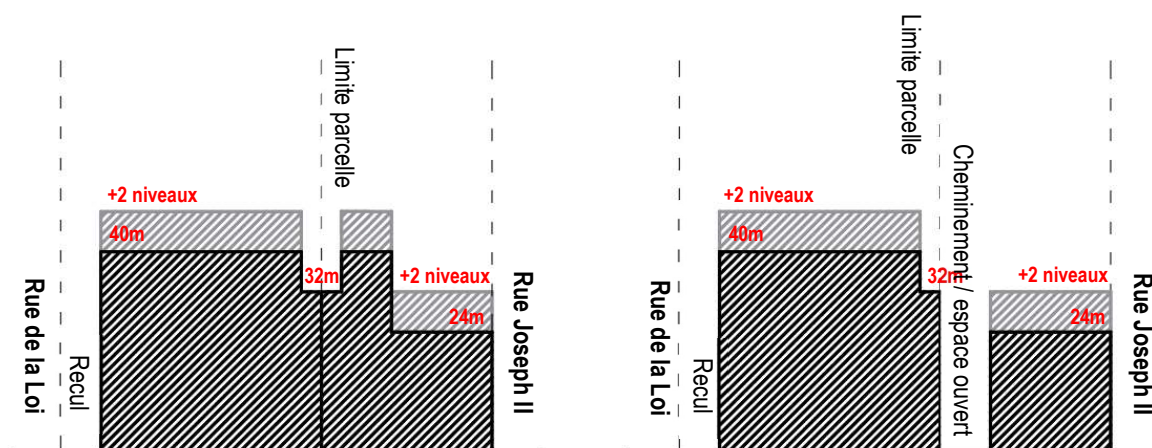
Exemples d'application des règles de distance entre constructions (îlot E) : test sans cheminement (à gauche) et test avec cheminement (à droite) (ARIES, 2019)
